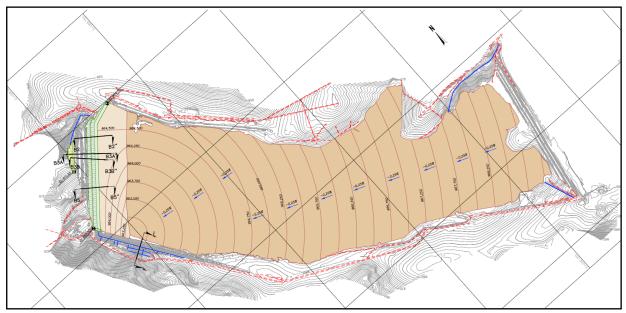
Arranjo Geral do projeto de descaracterização da Barragem B5.
